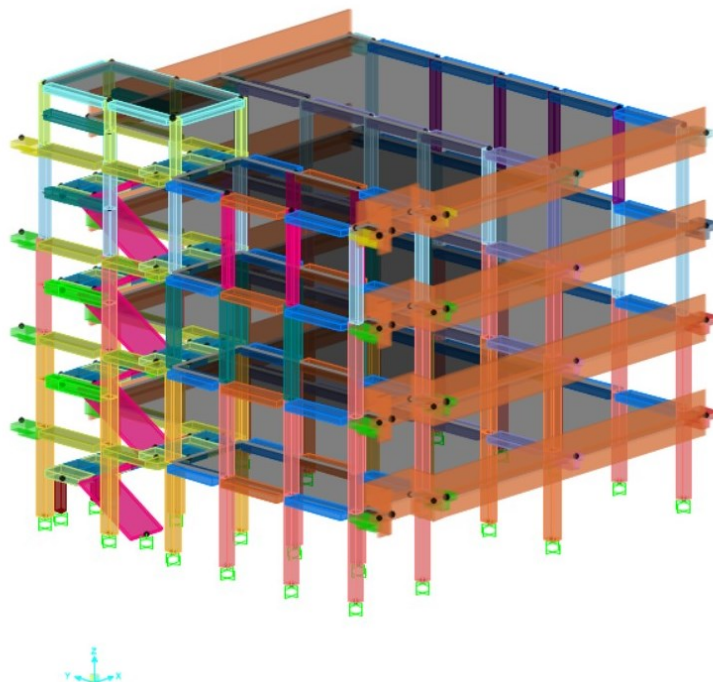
Sezione dell'organismo strutturale al sap2000.
